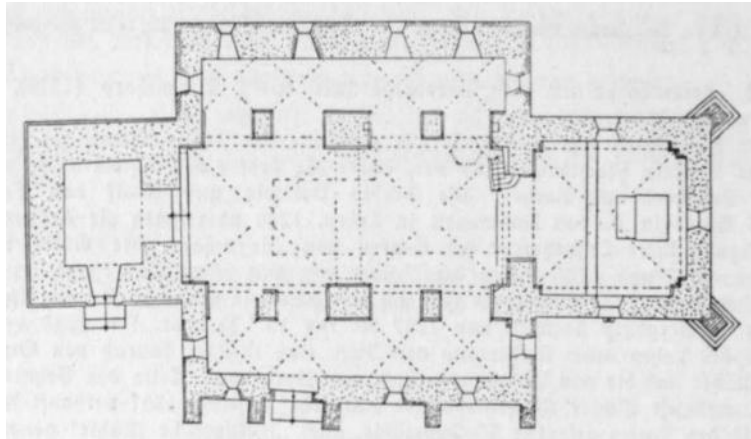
Kirche in Berndorf – Grundriss [1]
